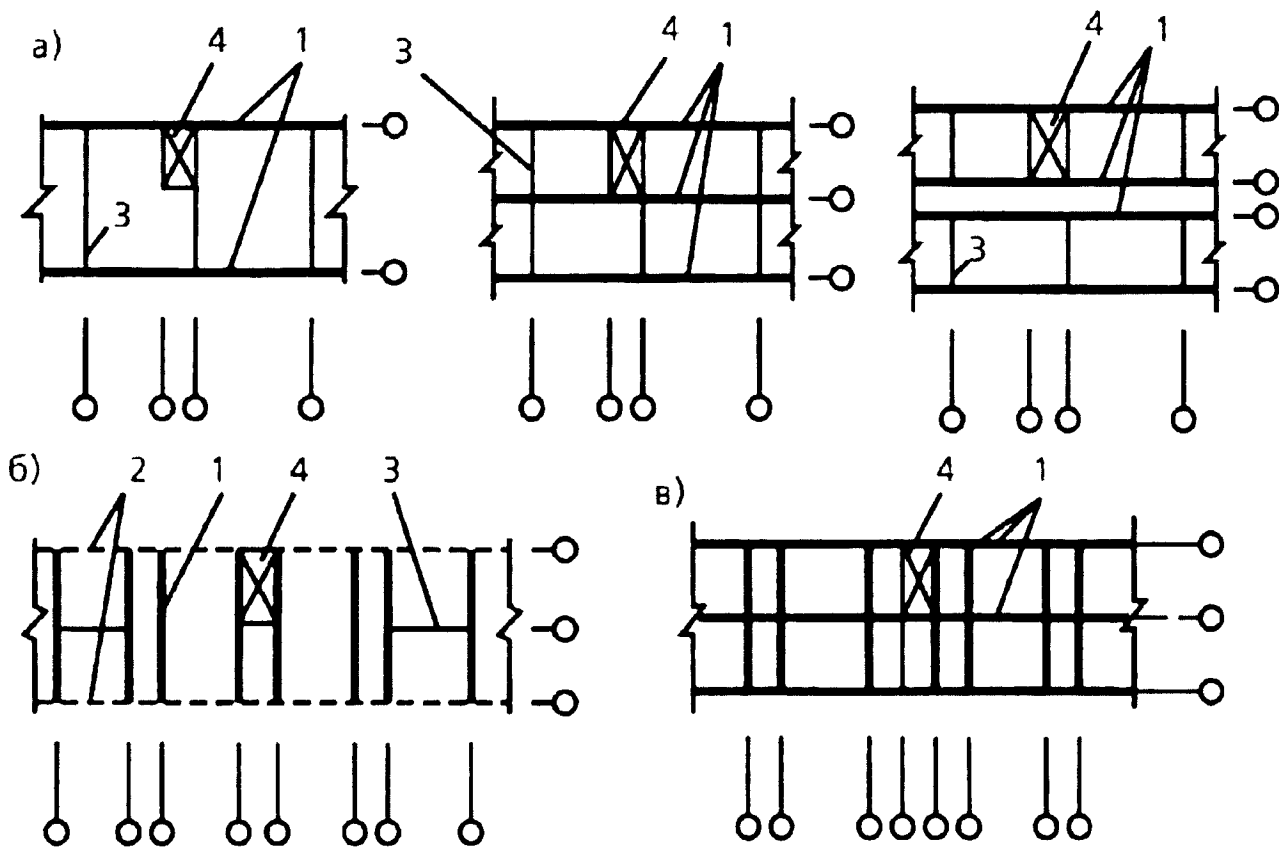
Конструктивные схемы в бескаркасной (стеновой) системе; а - с продольными несущими стенами и поперечными диафрагмами жесткости; б - с поперечными несущими стенами и продольными диафрагмами жесткости; в - с перекрестно расположенными несущими стенами; 1 - несущие стены; 2 - самонесущие (ненесущие) стены; 3 - диафрагмы жесткости; 4 - лестничные клетки
